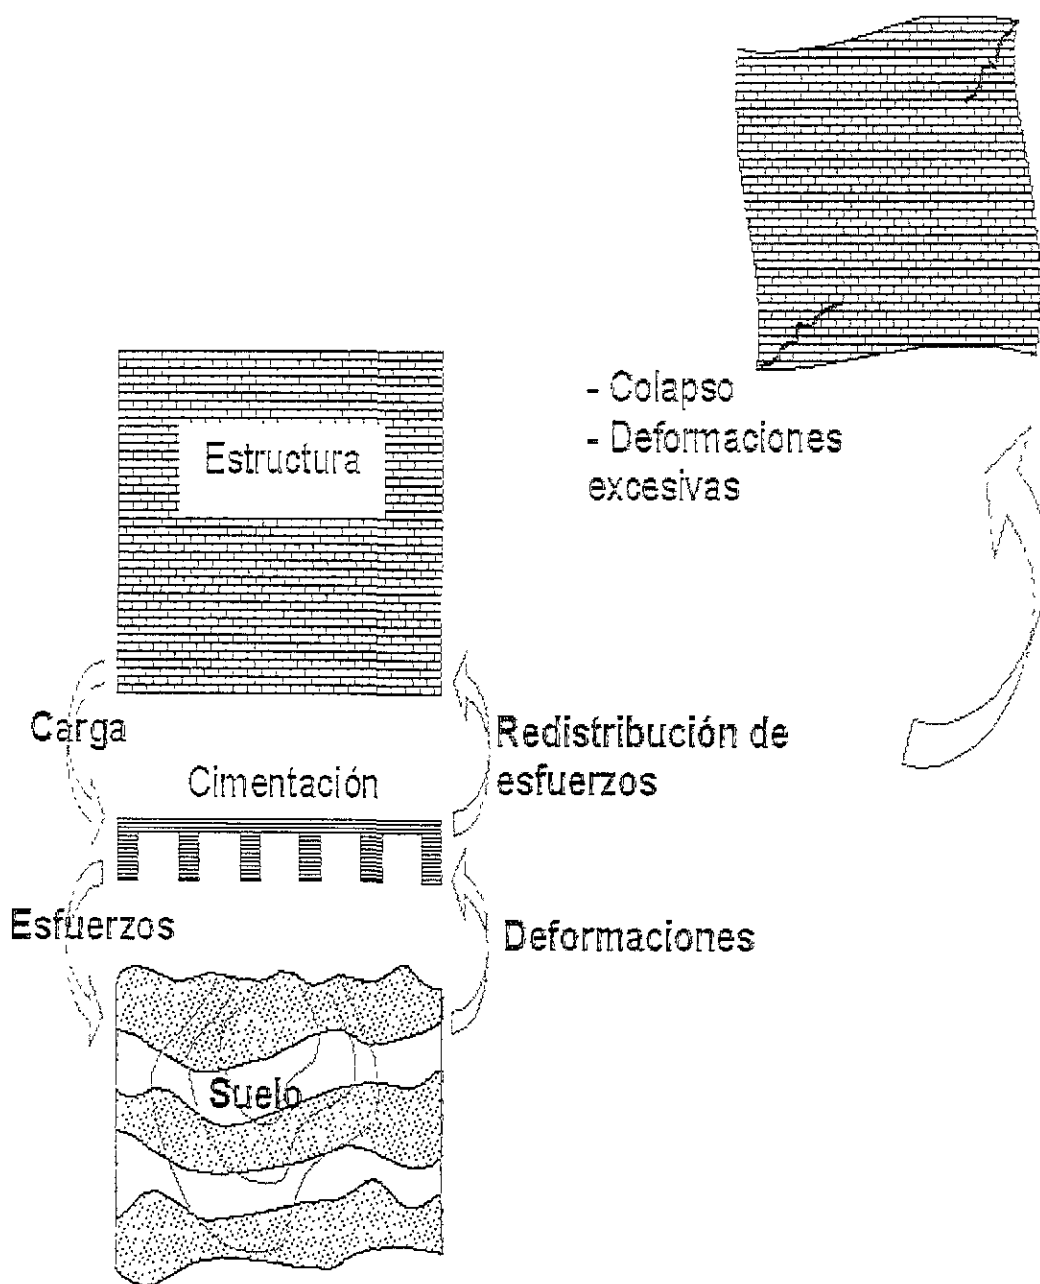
Trabajo conjunto: Estructura ↔ Cimentación ↔ Suelo.
